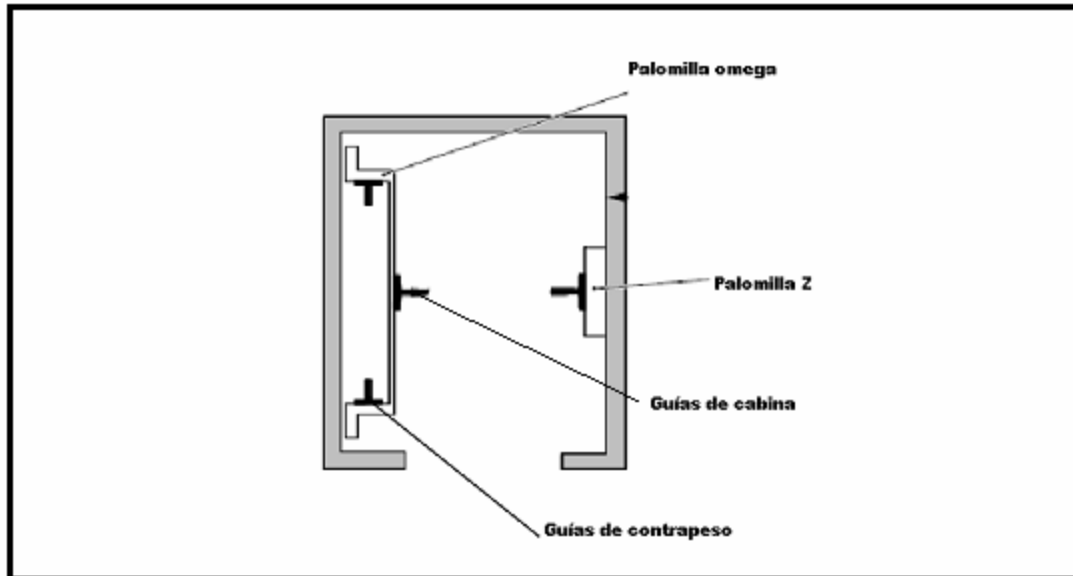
Plano en planta de la colocación de las palomillas
